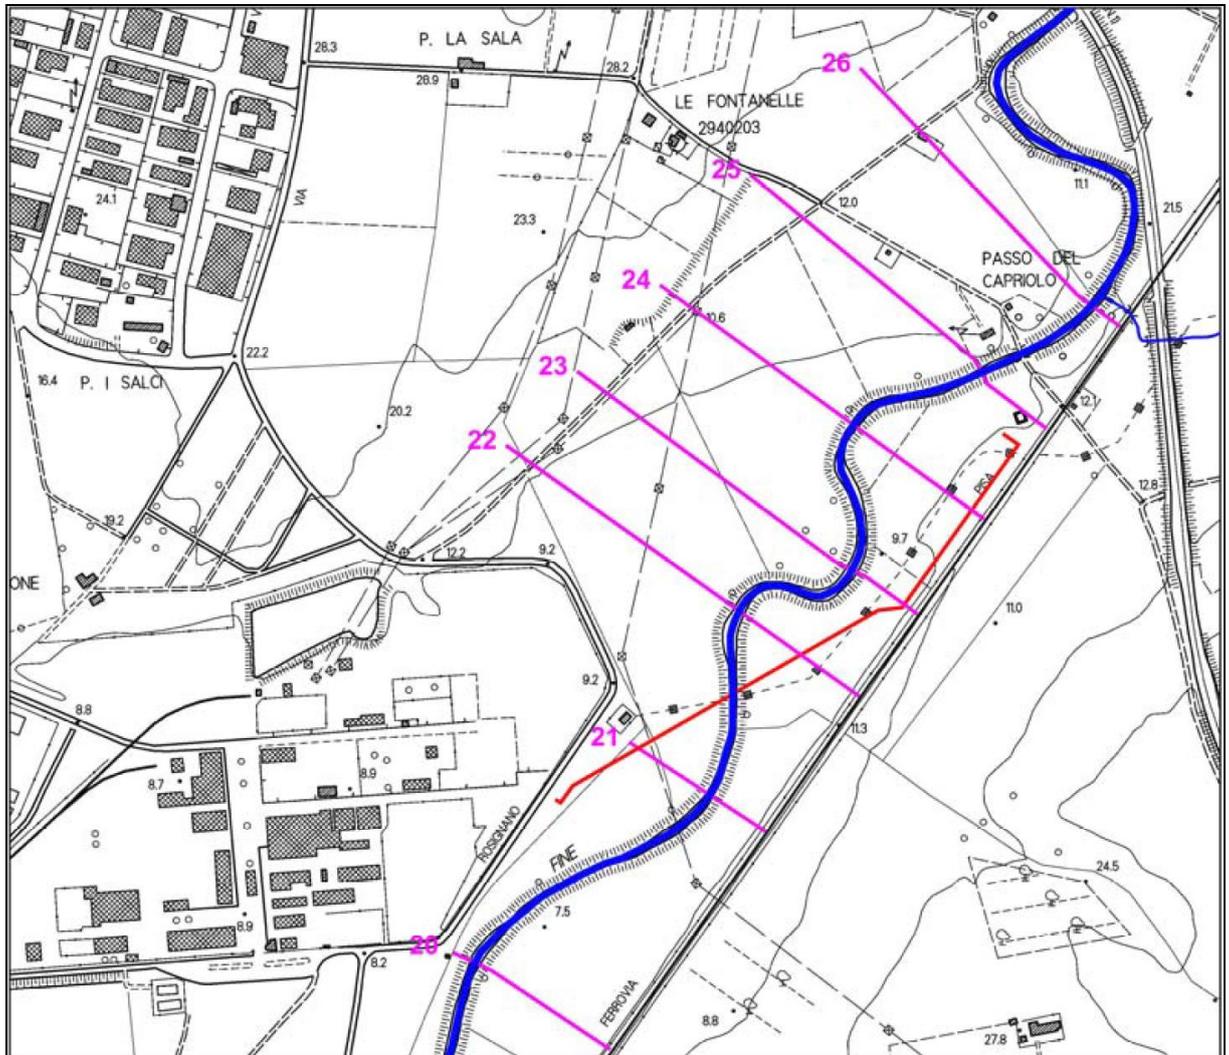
/A: Stralcio planimetrico, con ubicazione delle sezioni di modellazione e met. in progetto
